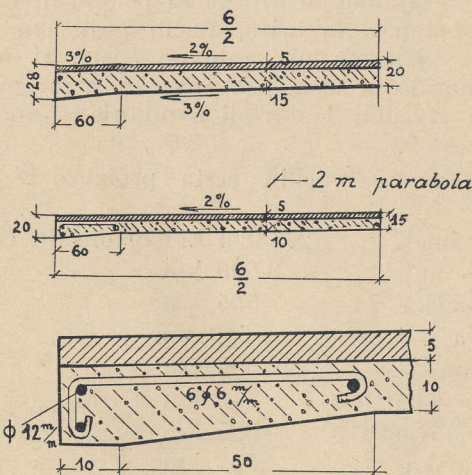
Betonska cesta za naše prilike: gornji sloj 7 cm od betona sa 400 kg cementa, donji sloj 8 cm sa 220 kg cementa.
